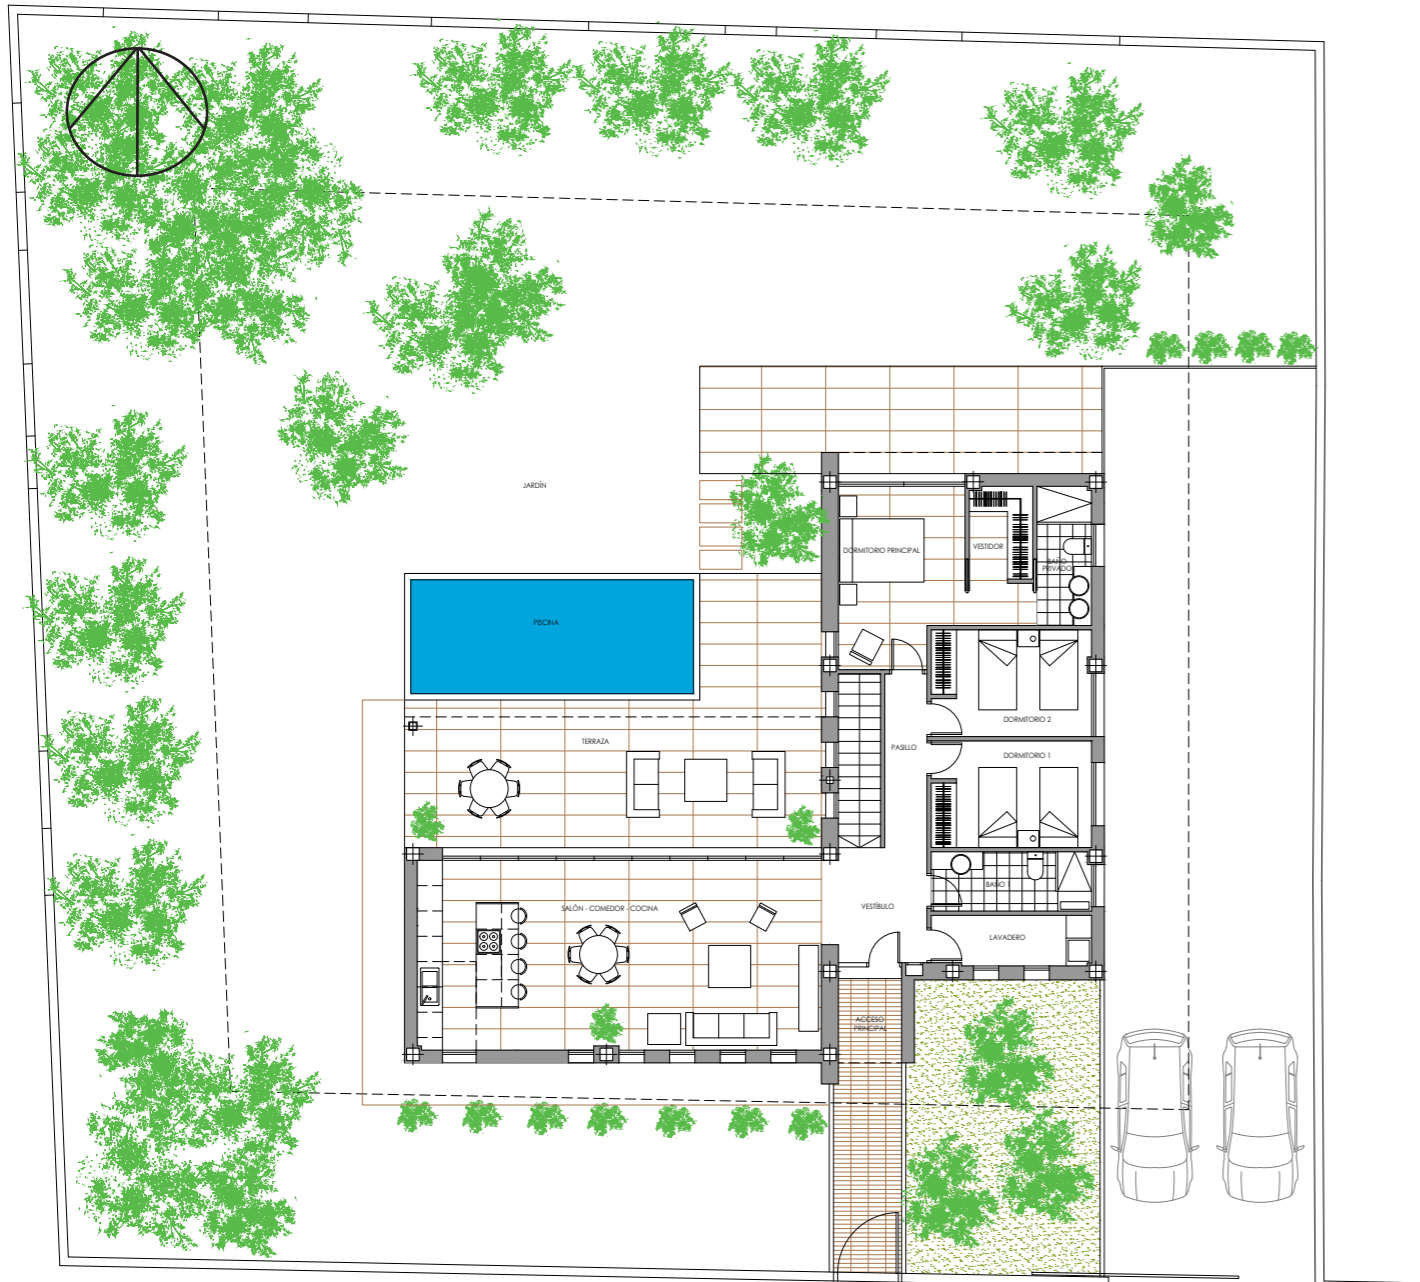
Planta baja de Propuesta de modificación del proyecto de vivienda unifamiliar aislada con piscina. Casa Vall dels Alcalans. Elaboración propia.
